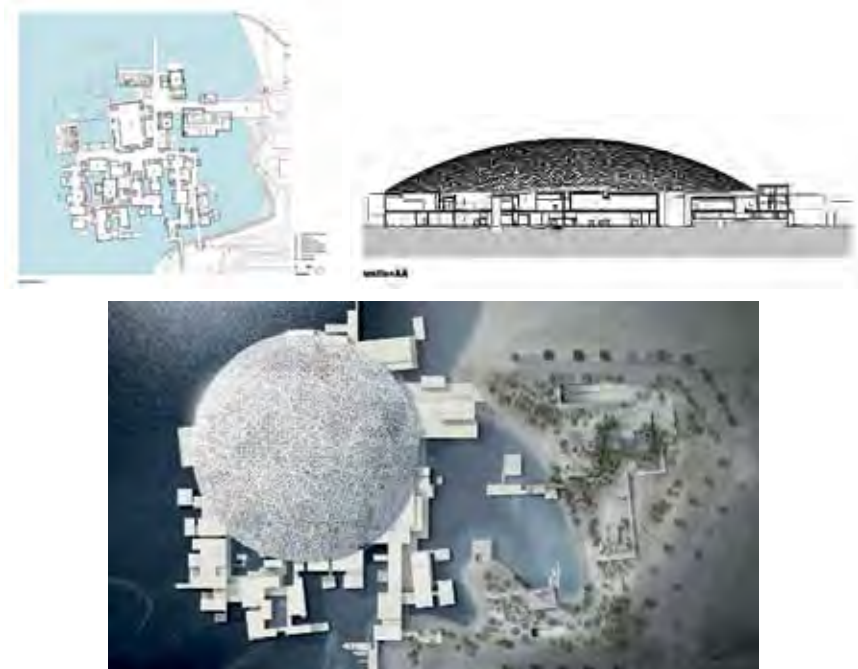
План, разрез, генеральный план Лувра Абу-Даби
